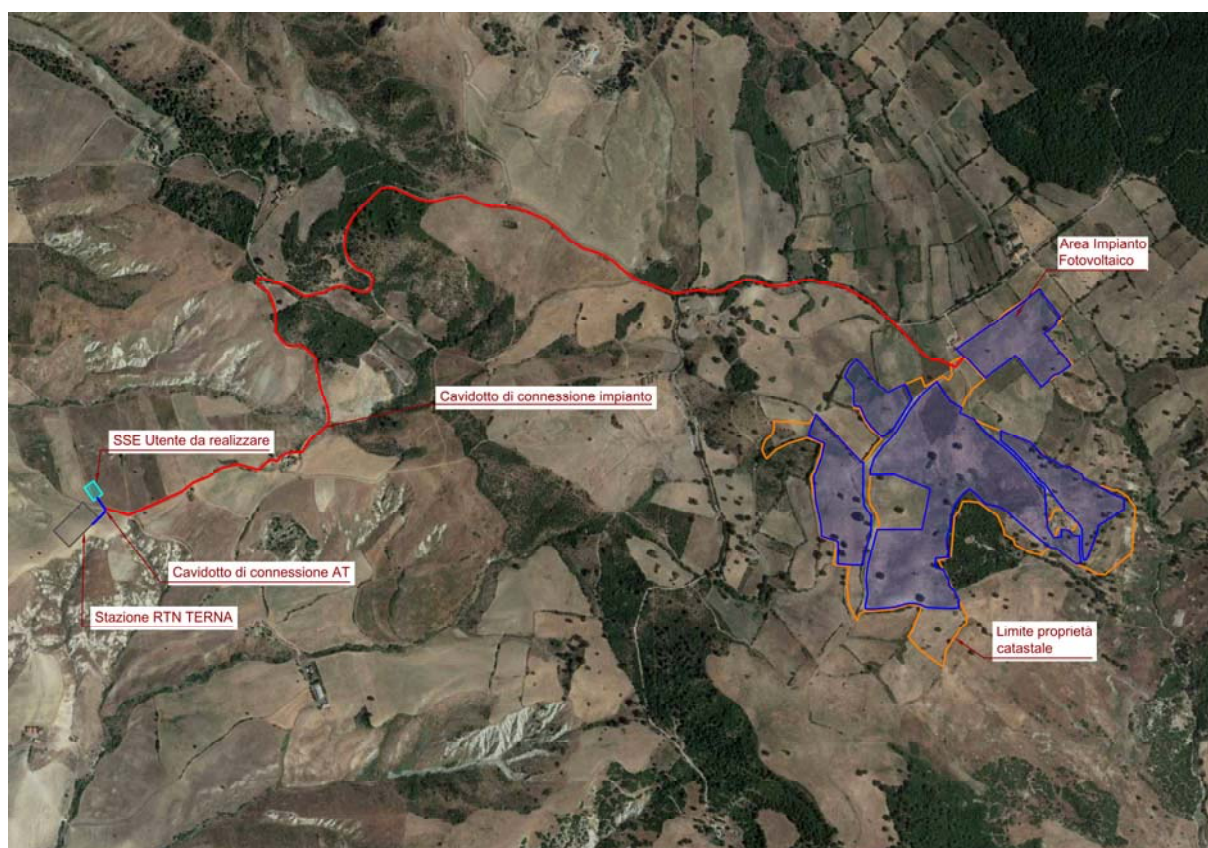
Layout impianto e tracciato di connessione su ortofoto
